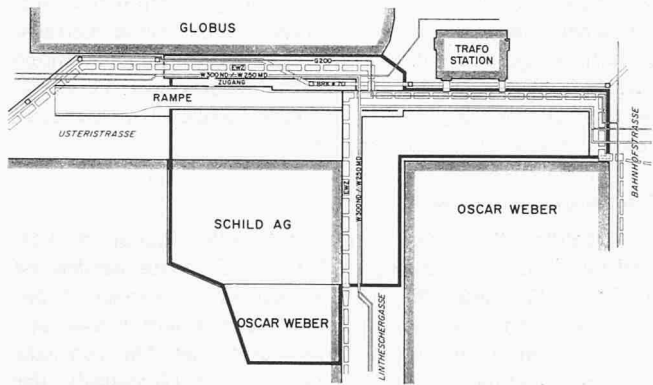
Grundriss im ersten Untergeschoss 1:700. Anlieferung und Werkleitungskulisse
